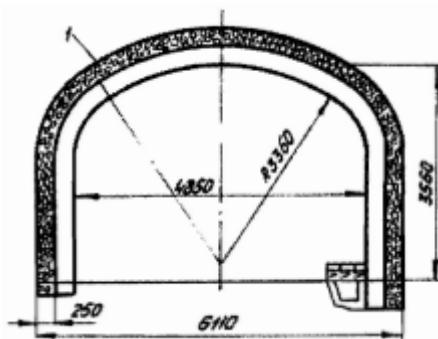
Монолитная бетонная крепь с податливым слоем
